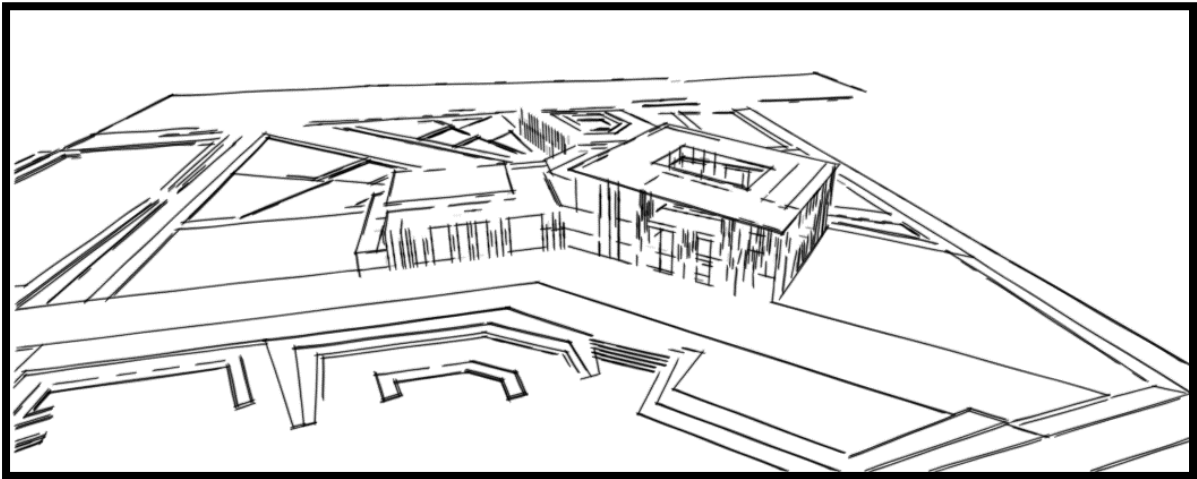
5 : Présentation du plan de du projet avec l'espace extérieur
